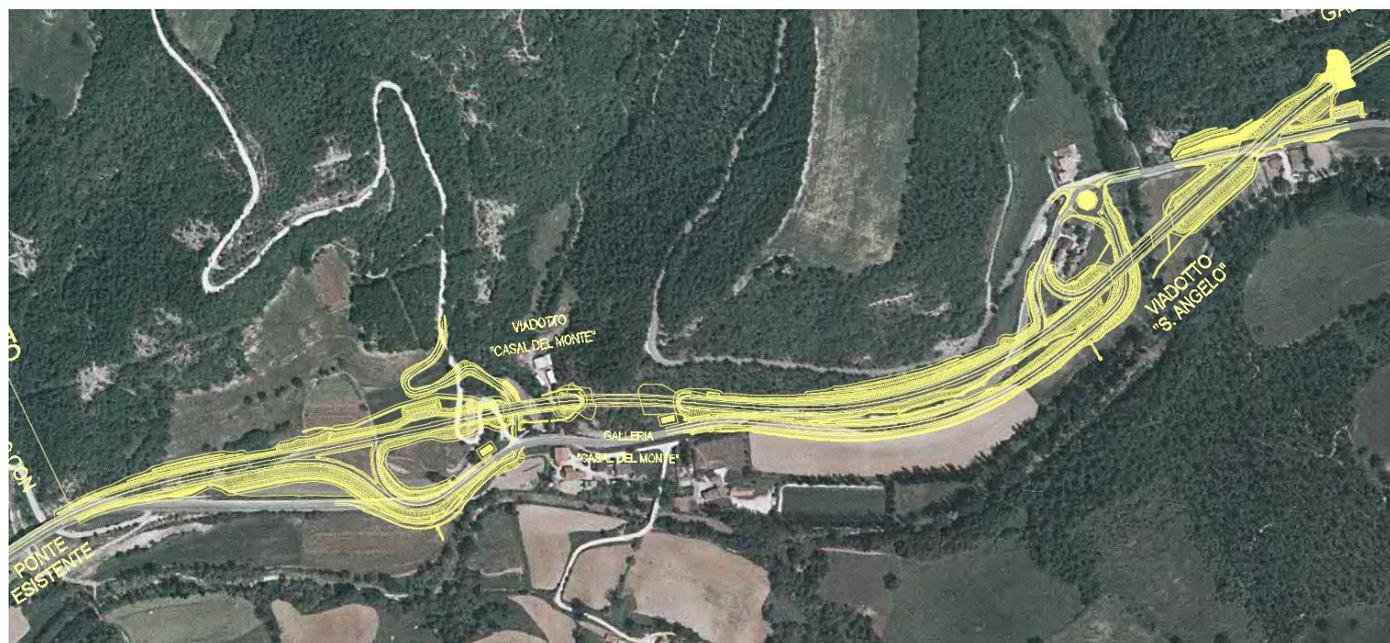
TRATTO DA INIZIO LOTTO ALL'IMBOCCO DELLA GALLERIA "PIETRALUNGA 1"
